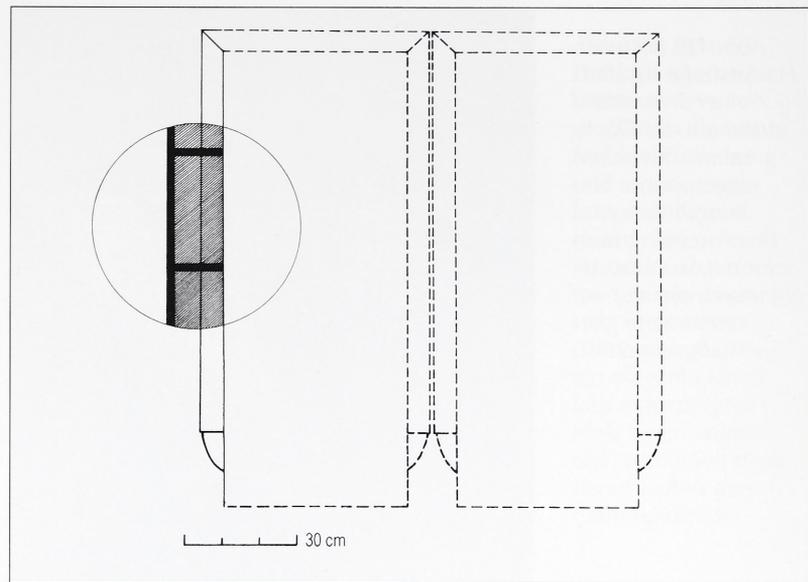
Rottweil, Hauptstraße 41. Rekonstruierte Außenansicht einer Fensteröffnung zu den Grundrissen in Abb. 16 mit Einzeichnung des ursprünglichen Farbbefunds.
